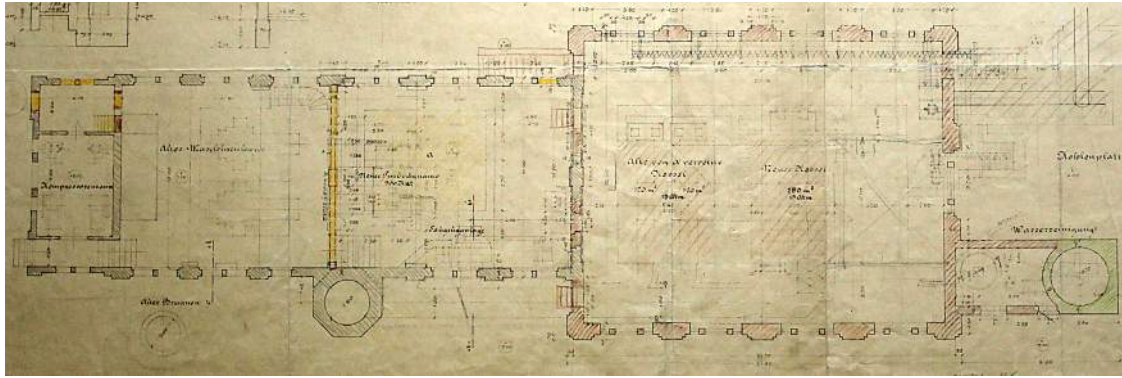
Grundrissdarstellung des rot markierten Zubaus; November 1917
